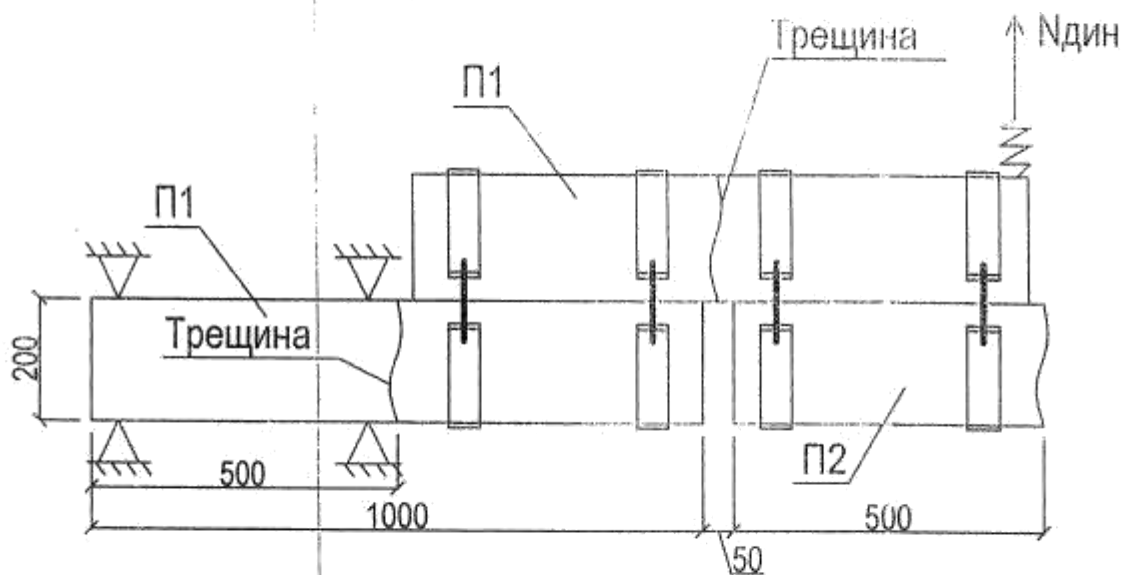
Схемы испытаний блоков со стеклопластиковой арматурой.
